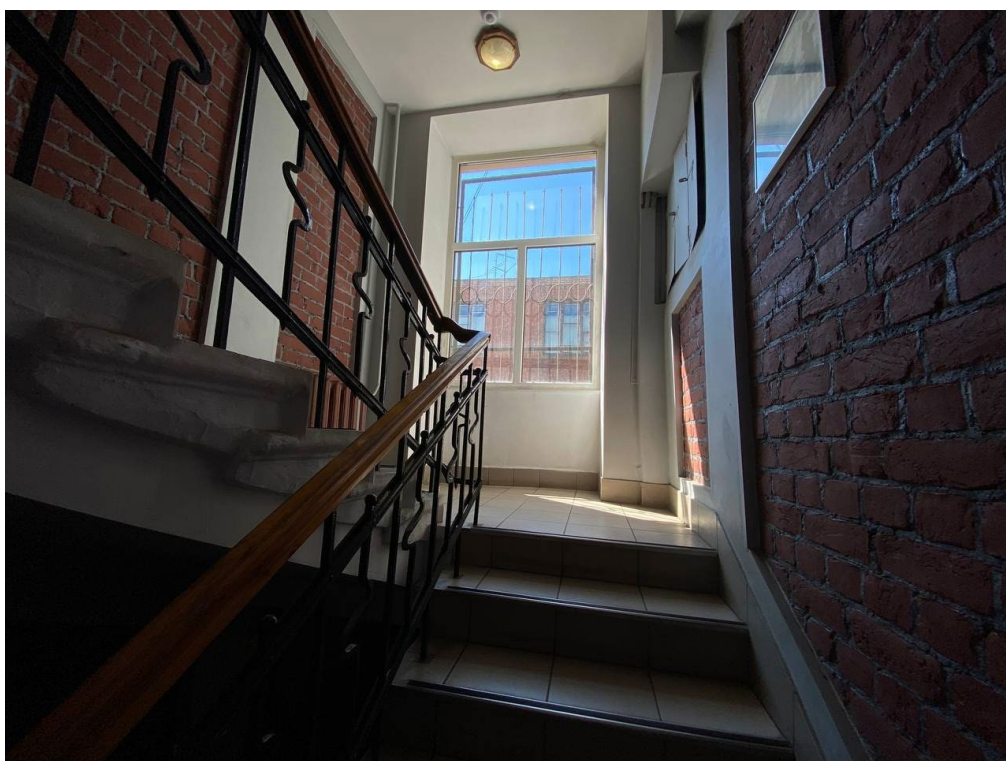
Лестница в южной части здания, вид с лестничного марша на междуэтажную площадку.
